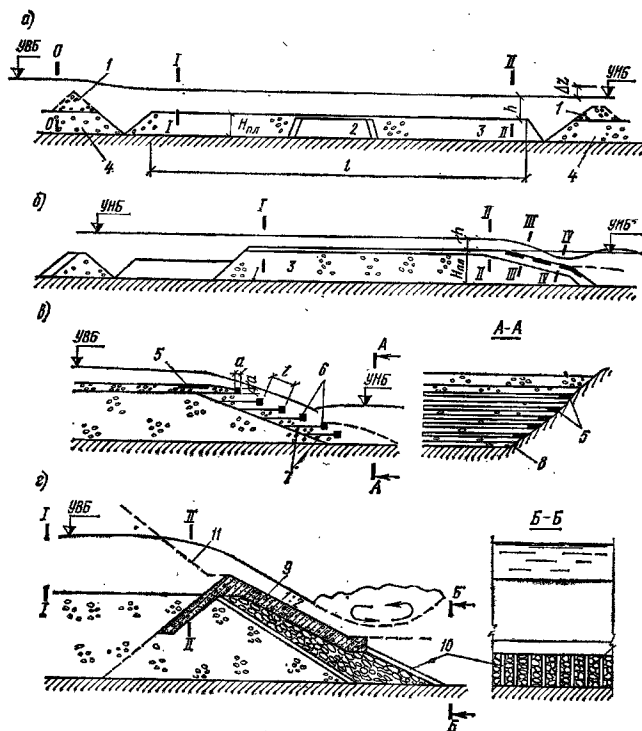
Пропуск паводка через недостроенную плотину по схеме водослива с широким порогом а и б — соответственно затопленный и незатопленный профиль недостроенной плотины; в и г — соответственно балочное и железобетонное крепление низового откоса; 1 — верхняя и низовая перемычки, размываемые в паводок; 2 — ядро; 3 — горная масса; 4 — русловой аллювий; 5 — полосы омоноличенного бетоном камня; 6 — железобетонные или деревянные балки ($a > 0,7d_{30}$; $l = 4d_{30}$); 7 — анкеры; 8 — крупный камень; 9 — железобетонный водослив; 10 — опорные балки; 11 — проектный профиль плотины
